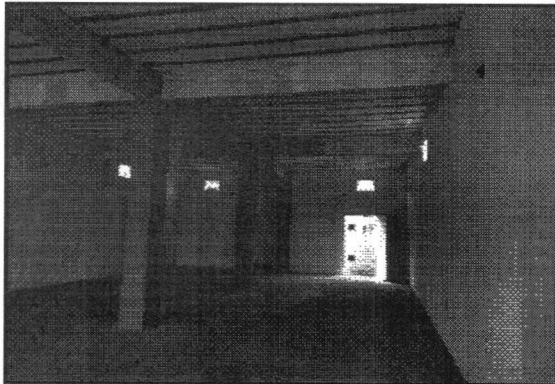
Vista da Galpão, com aos pilares de concreto armado no centro.
